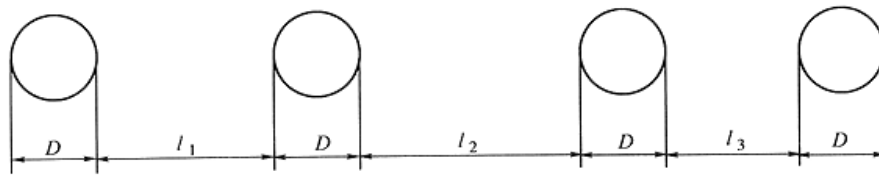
Расчетная ширина бокового давления грунта столба
